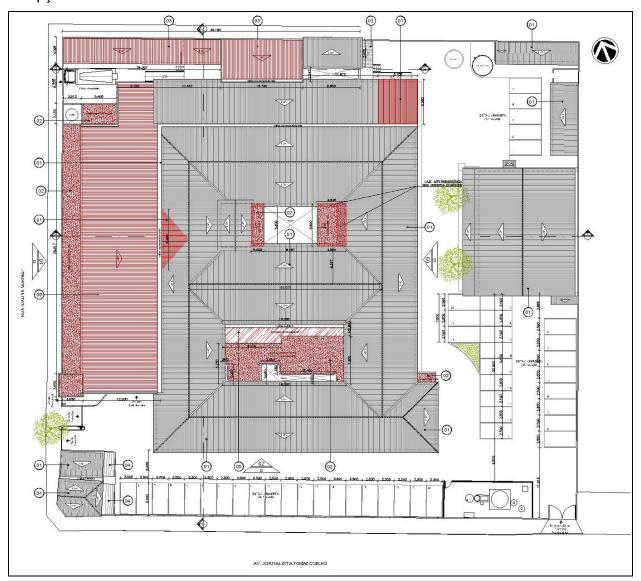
Planta de Implantação – Hospital Frotinha de Messejana
